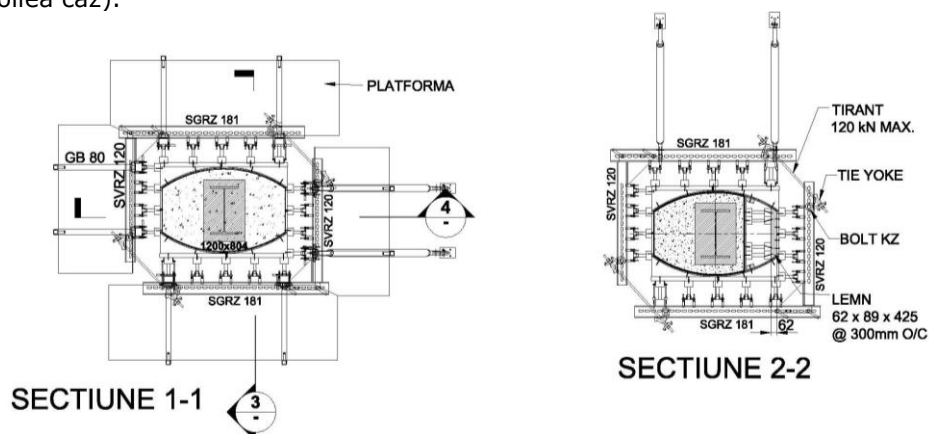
Secțiunea 1-1 și 2-2 în plan în cazul „remodelării” unei structuri („Vario”)
